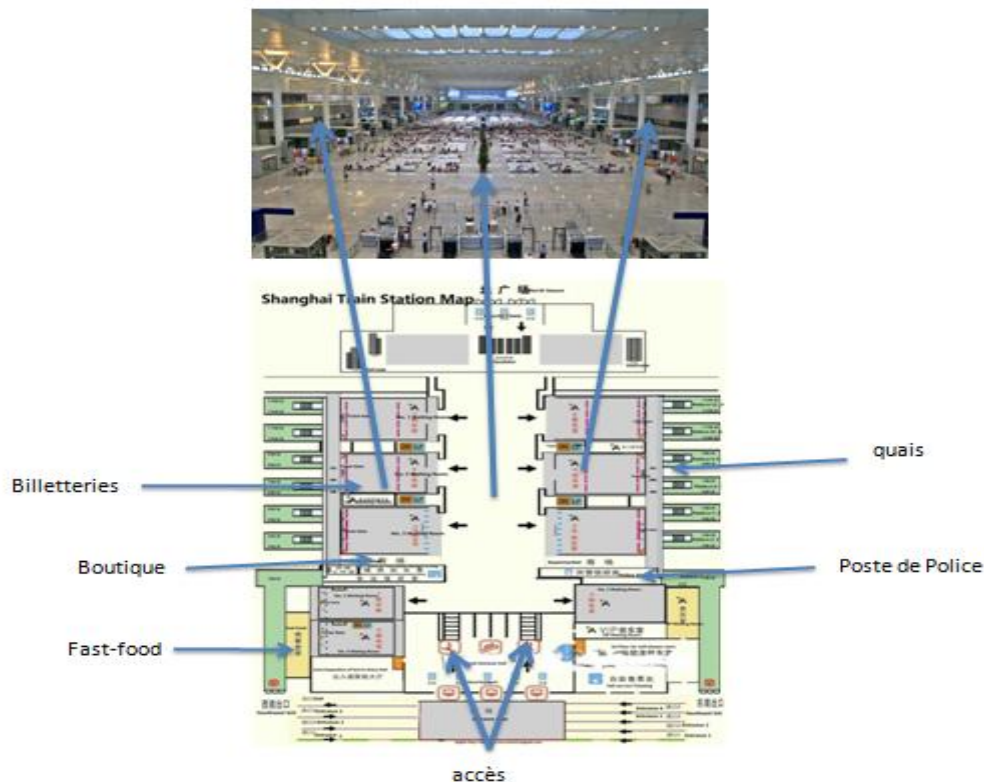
plan de la salle d'attente +les quais en détail, réadapter par l'auteur
